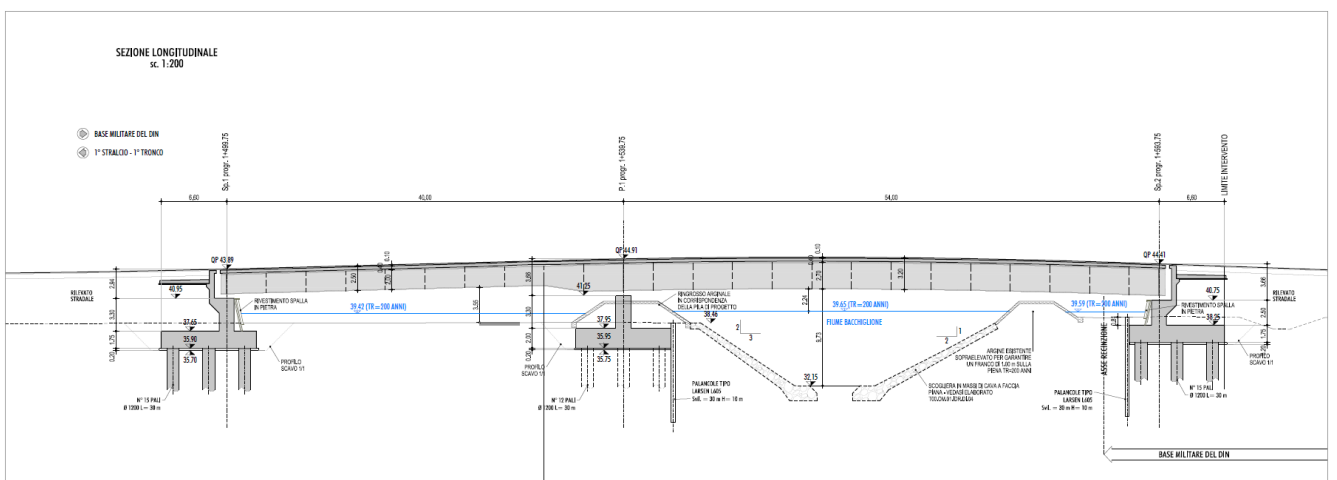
SEZIONE LONGITUDINALE DEL PONTE
